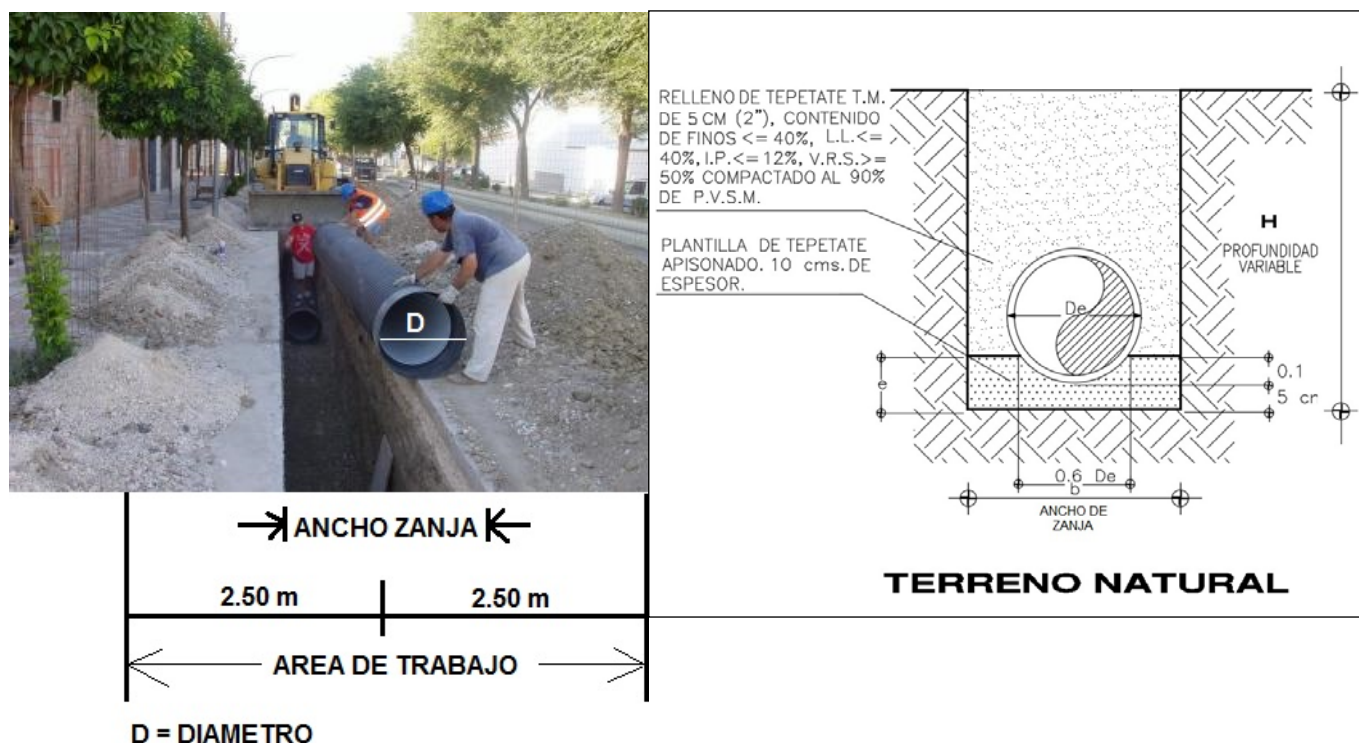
Ilustración de excavación de zanja e instalación de tubería.
